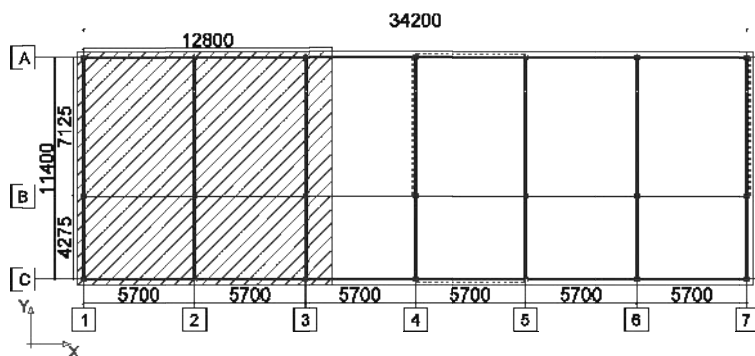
Rappresentazione in pianta - Configurazione asimmetrica (dimensioni in mm)
